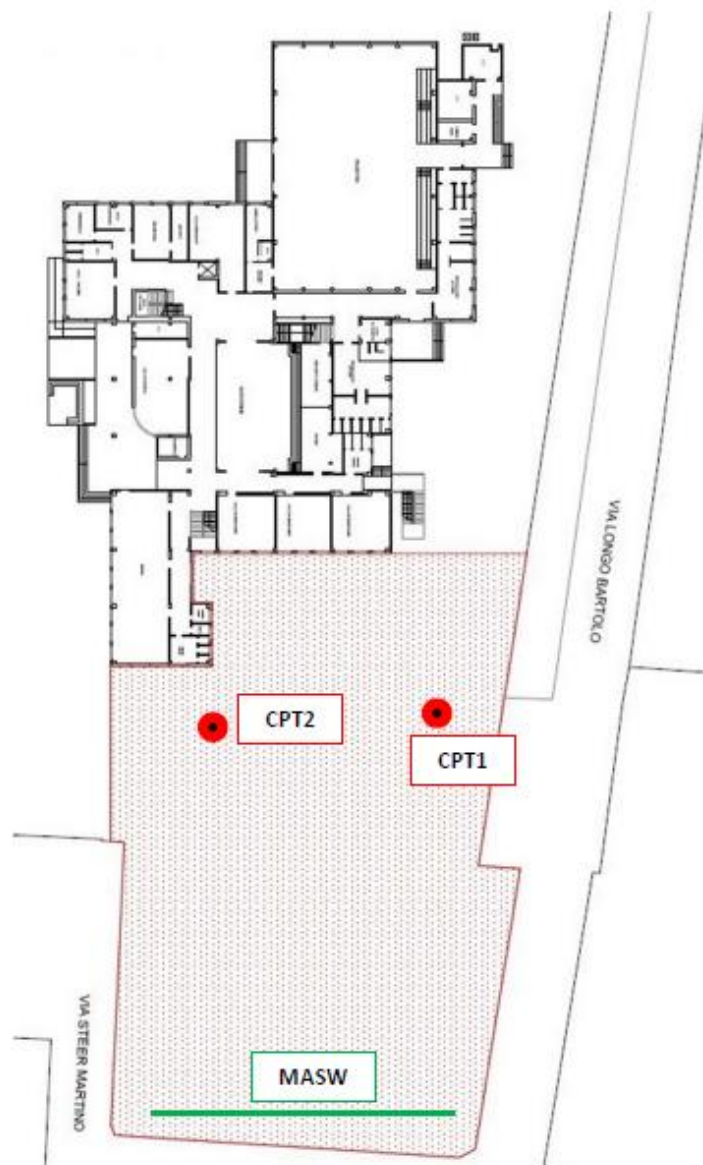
Planimetria con l'ubicazione delle indagini eseguite
